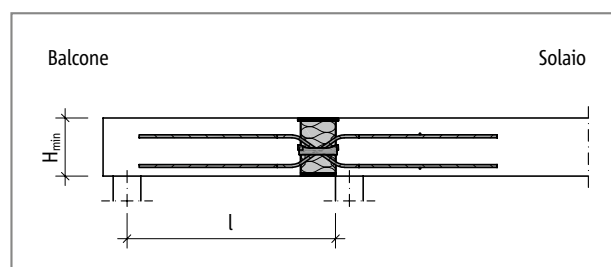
Schöck Isokorb® XT tipo QL-VV: schema statico (XT tipo QL-VV5 – VV8)
